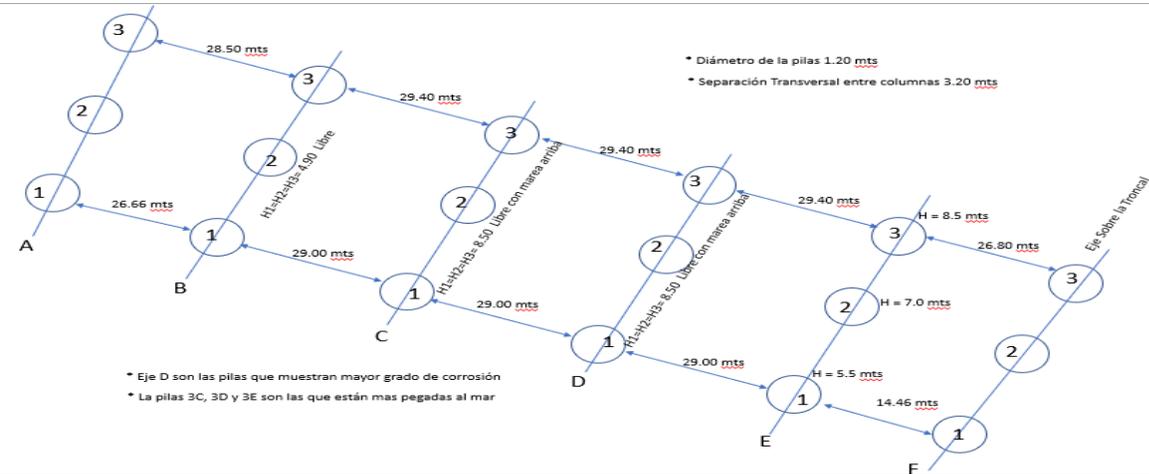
Levantamiento de los ejes de las Pilas de la Rampa # 31.
